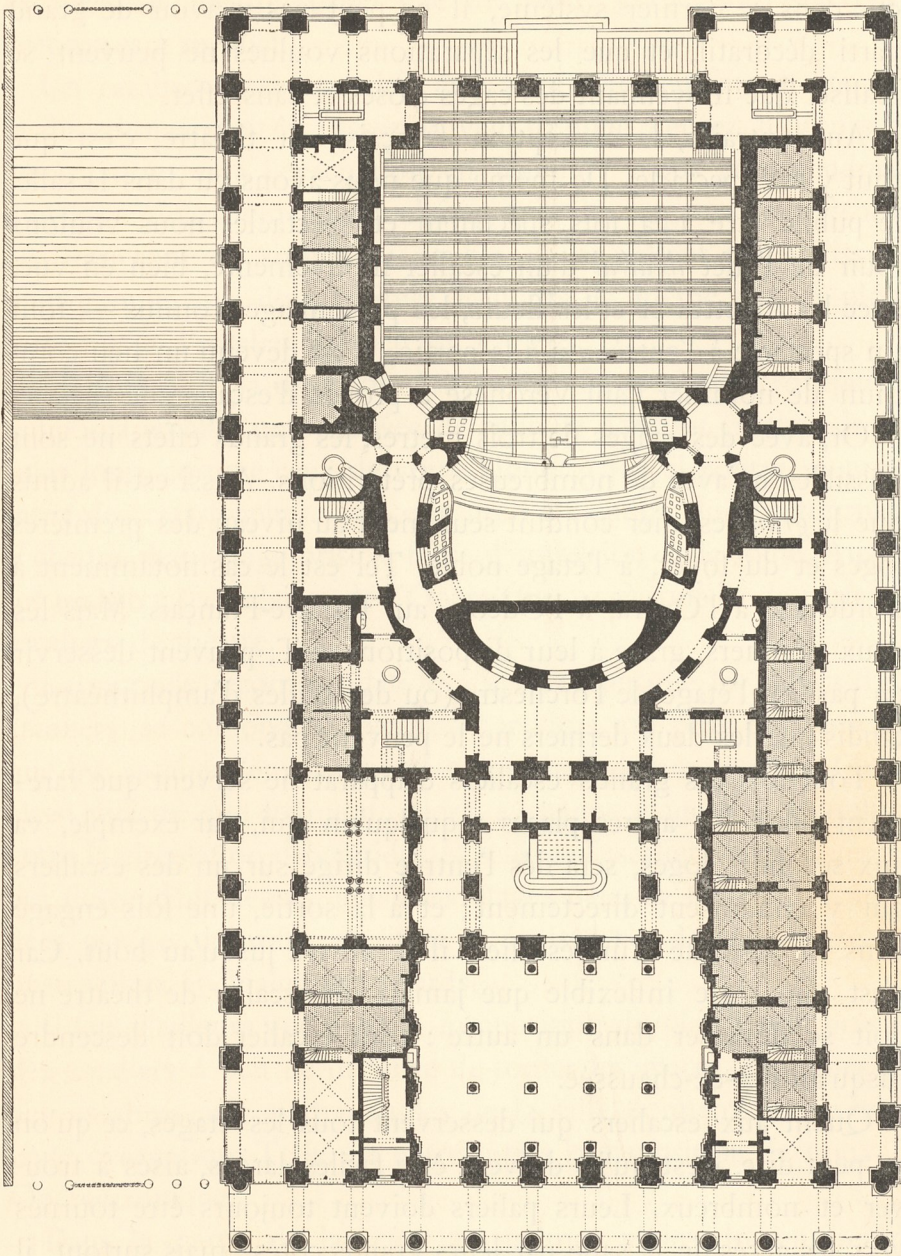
Théâtre de Bordeaux. Plan du rez-de-chaussée.
